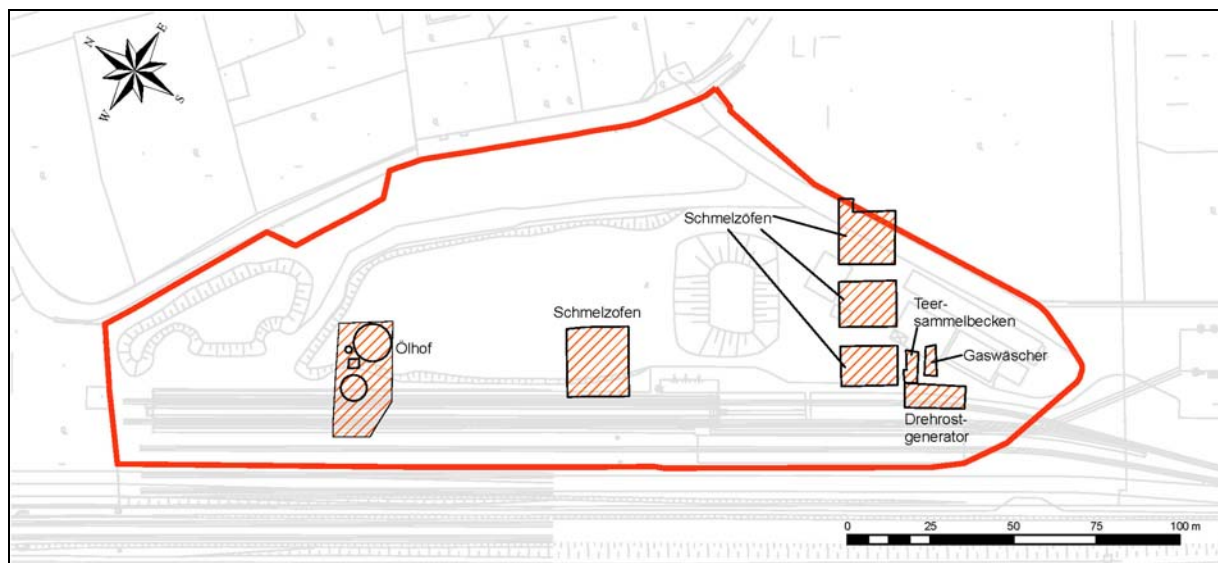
Lageplan der Betriebsanlagen (Stand 1956)
